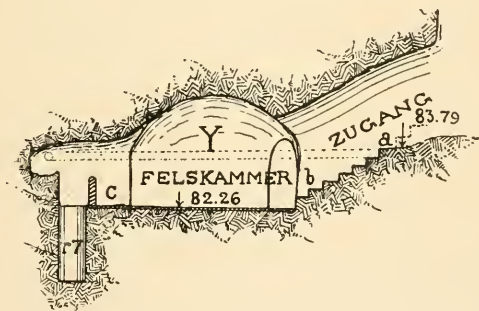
Durchschnitt nach E-F des Grundrisses Abb. 1.
